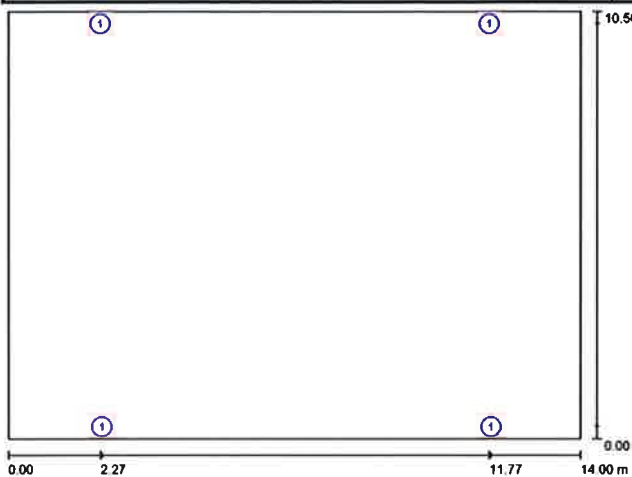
Disposizione apparecchi illuminanti S.P. n°7
